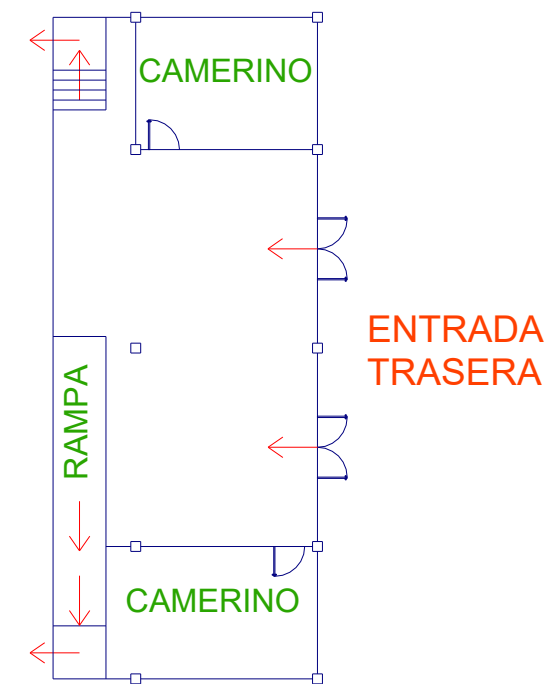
Distribución en planta de la Zona 3 del edificio.
